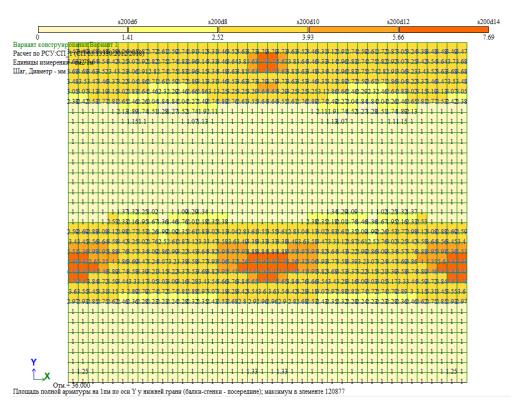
Требуемое нижнее армирование перекрытия по Y после усиления двусторонним наращиванием
